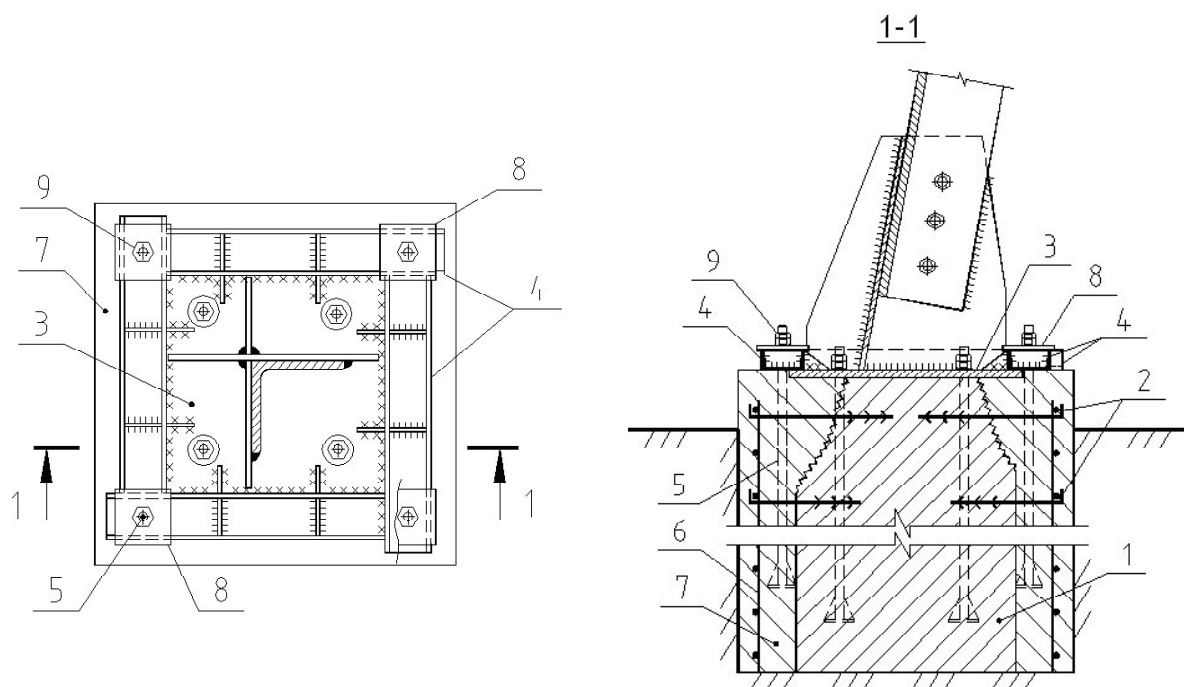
Усиление элементов узла опирания конструкции на фундамент: 1 — существующий фундамент; 2 — анкерные коротыши; 3 — опорная плита существующей базы стойки; 4 — элементы усиления; 5 — новые анкерные болты; 6 — арматурная сетка; 7 — новый фундамент; 8 — анкерные плитки; 9 — гайки.
